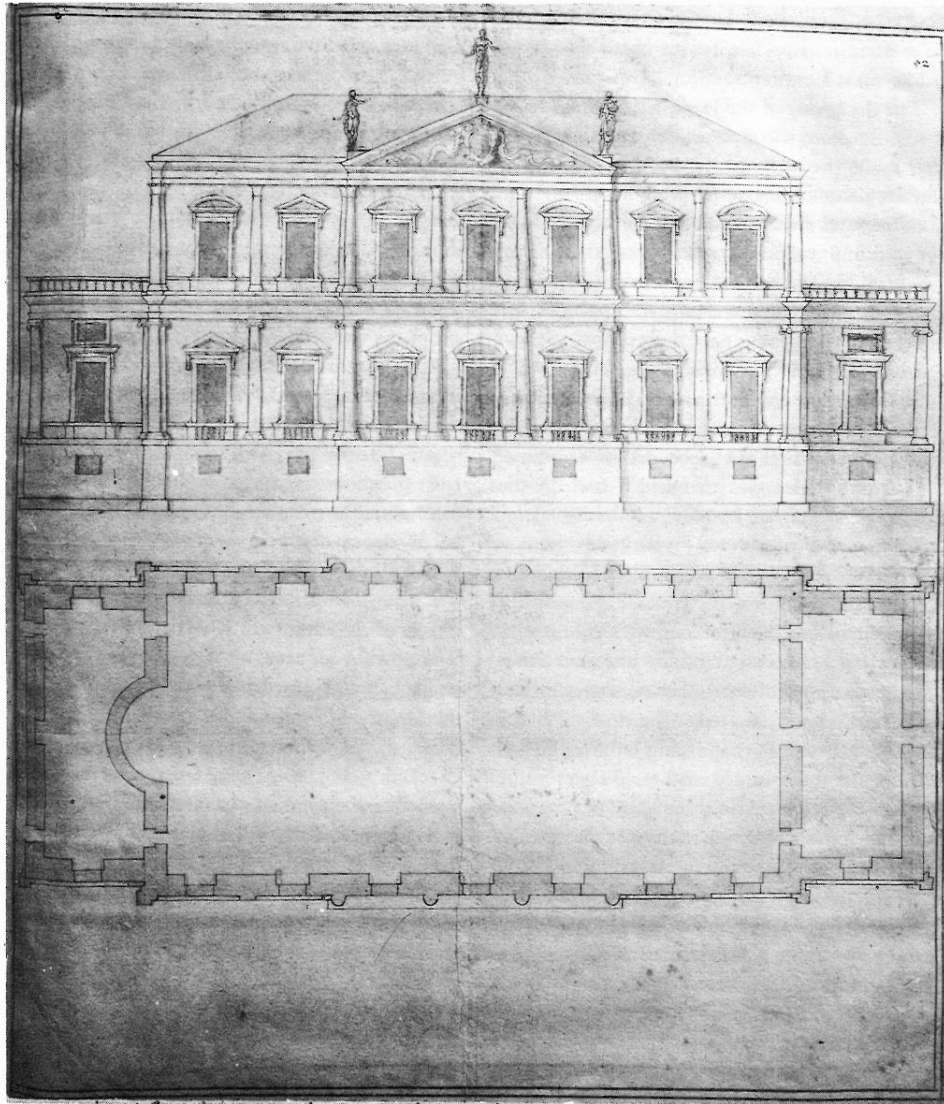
Inigo Jones: *Banqueting House*, Entwurf Hauptfassade/Grundriss, Whitehall/London
